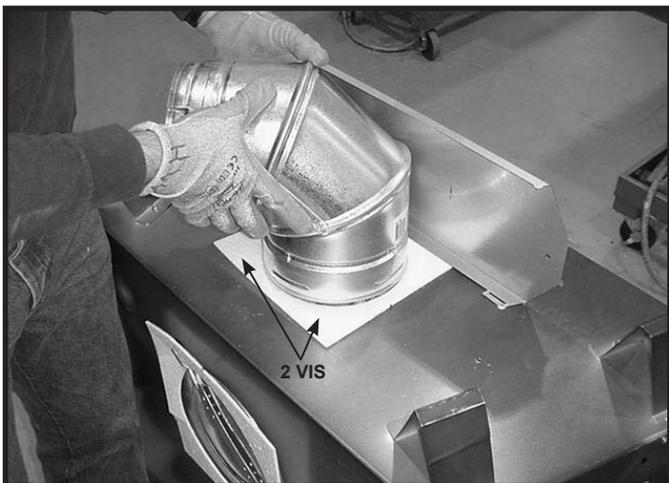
Pour fixer la première section du conduit d'évacuation, assurez-vous d'utiliser le joint d'étanchéité en fibre de verre pour sceller entre le premier composant et l'enveloppe extérieure du foyer. Utilisez 2 vis autotaraudeuses pour fixer le joint d'étanchéité à l'enveloppe extérieure.
